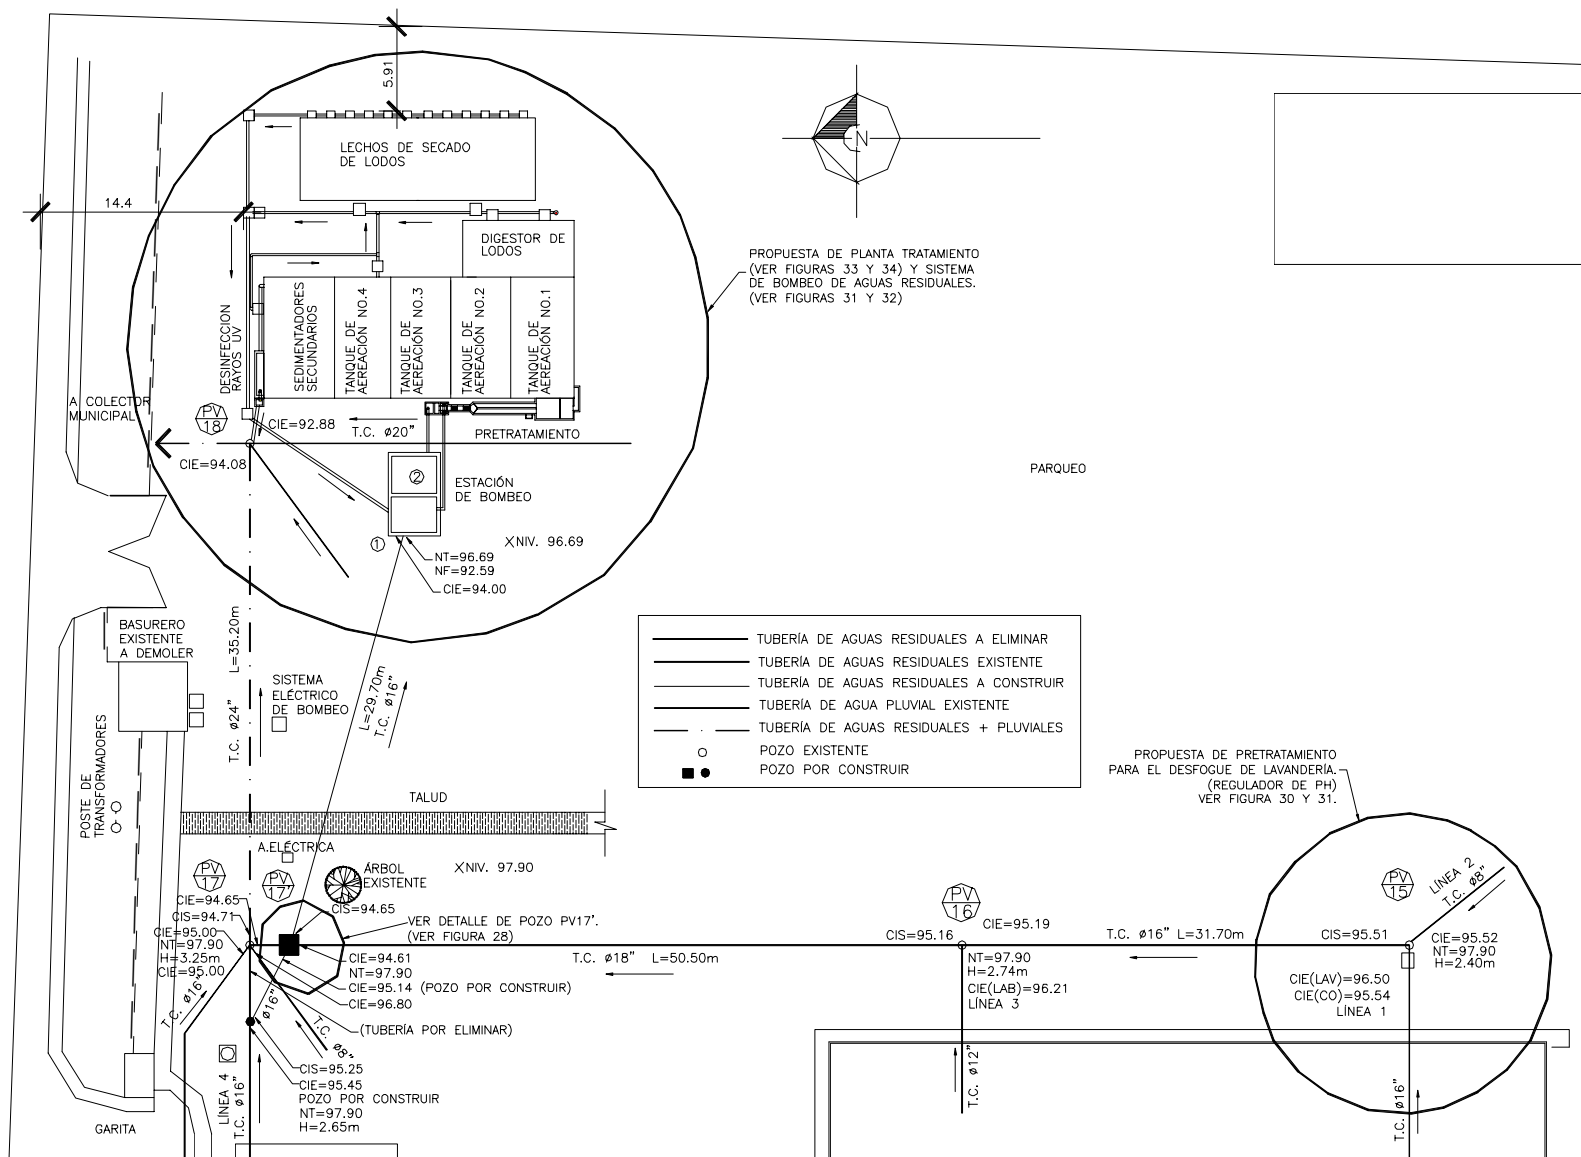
Ubicación general de la planta de tratamiento de lodos activados
